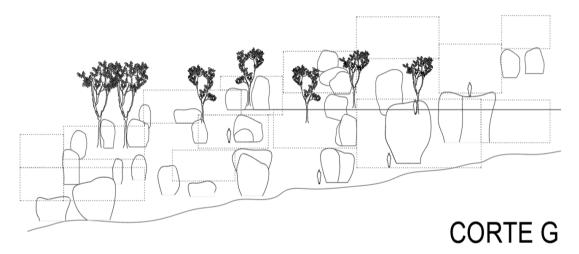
Corte longitudinal del terreno y la ubicación de las rocas-fuente elaboración propia
